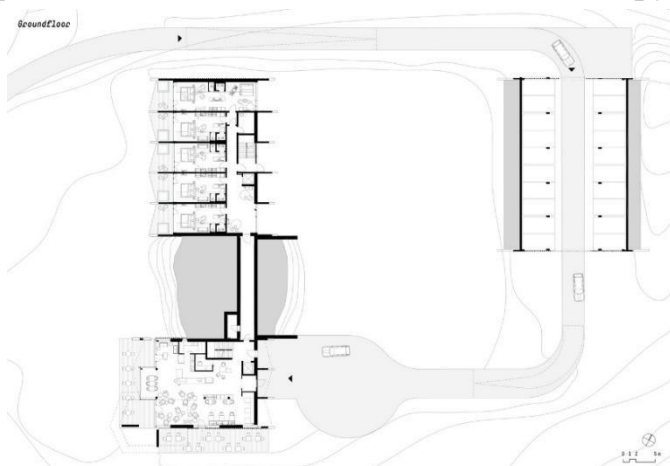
Aeon Hotel (Південний Тіроль, Італія) [3] – план 1-го поверху будівлі
